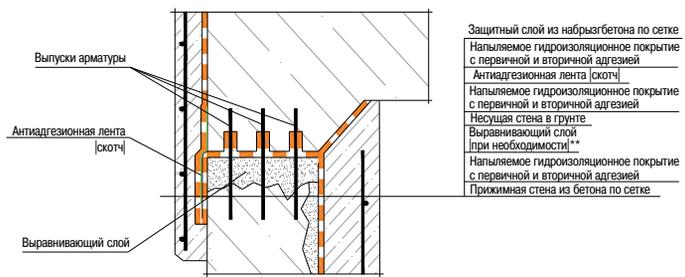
Устройство гидроизоляционной системы при открытом способе работ с использованием стены в грунте в качестве несущей. Узел 2
